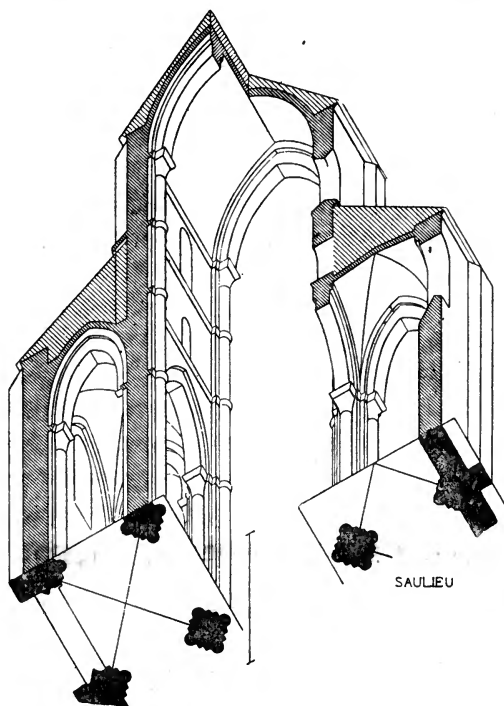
Chiesa di Saulieu, pianta e sezioni. (Choisy)
